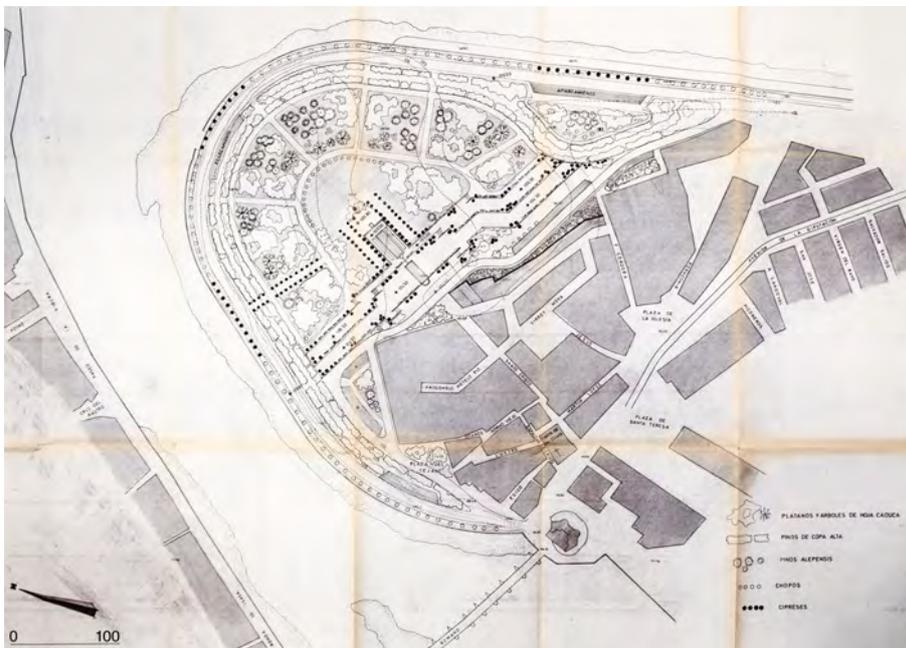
Plano de estado actual de edificios y solares de la Huerta de Miraflores (1960). E. 1/500.
